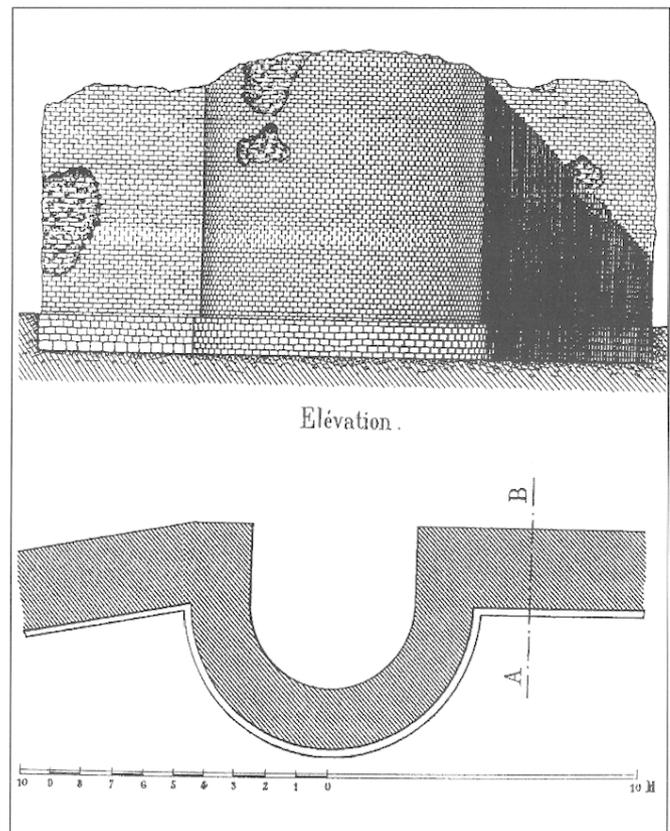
Plan et élévation d'une tour (Roidot-Deléage, 1878, pl. IV). Ce dessin est inexact, les tours étant en fait toutes parfaitement circulaires.
